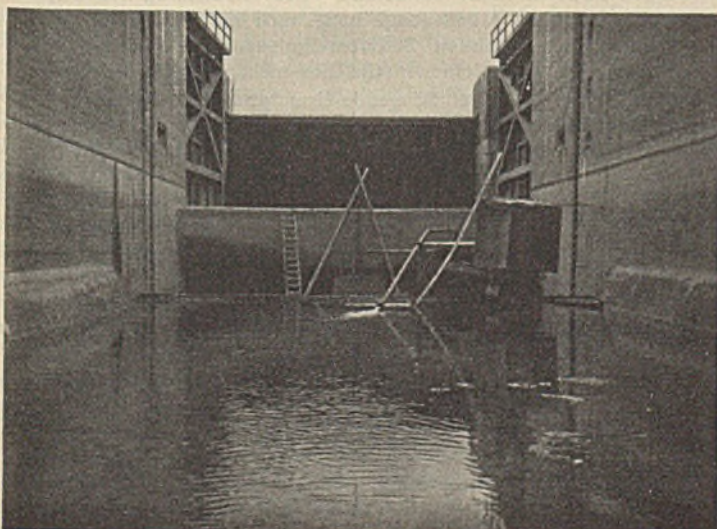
Oberhaupt mit eingebautem Notverschluß.
